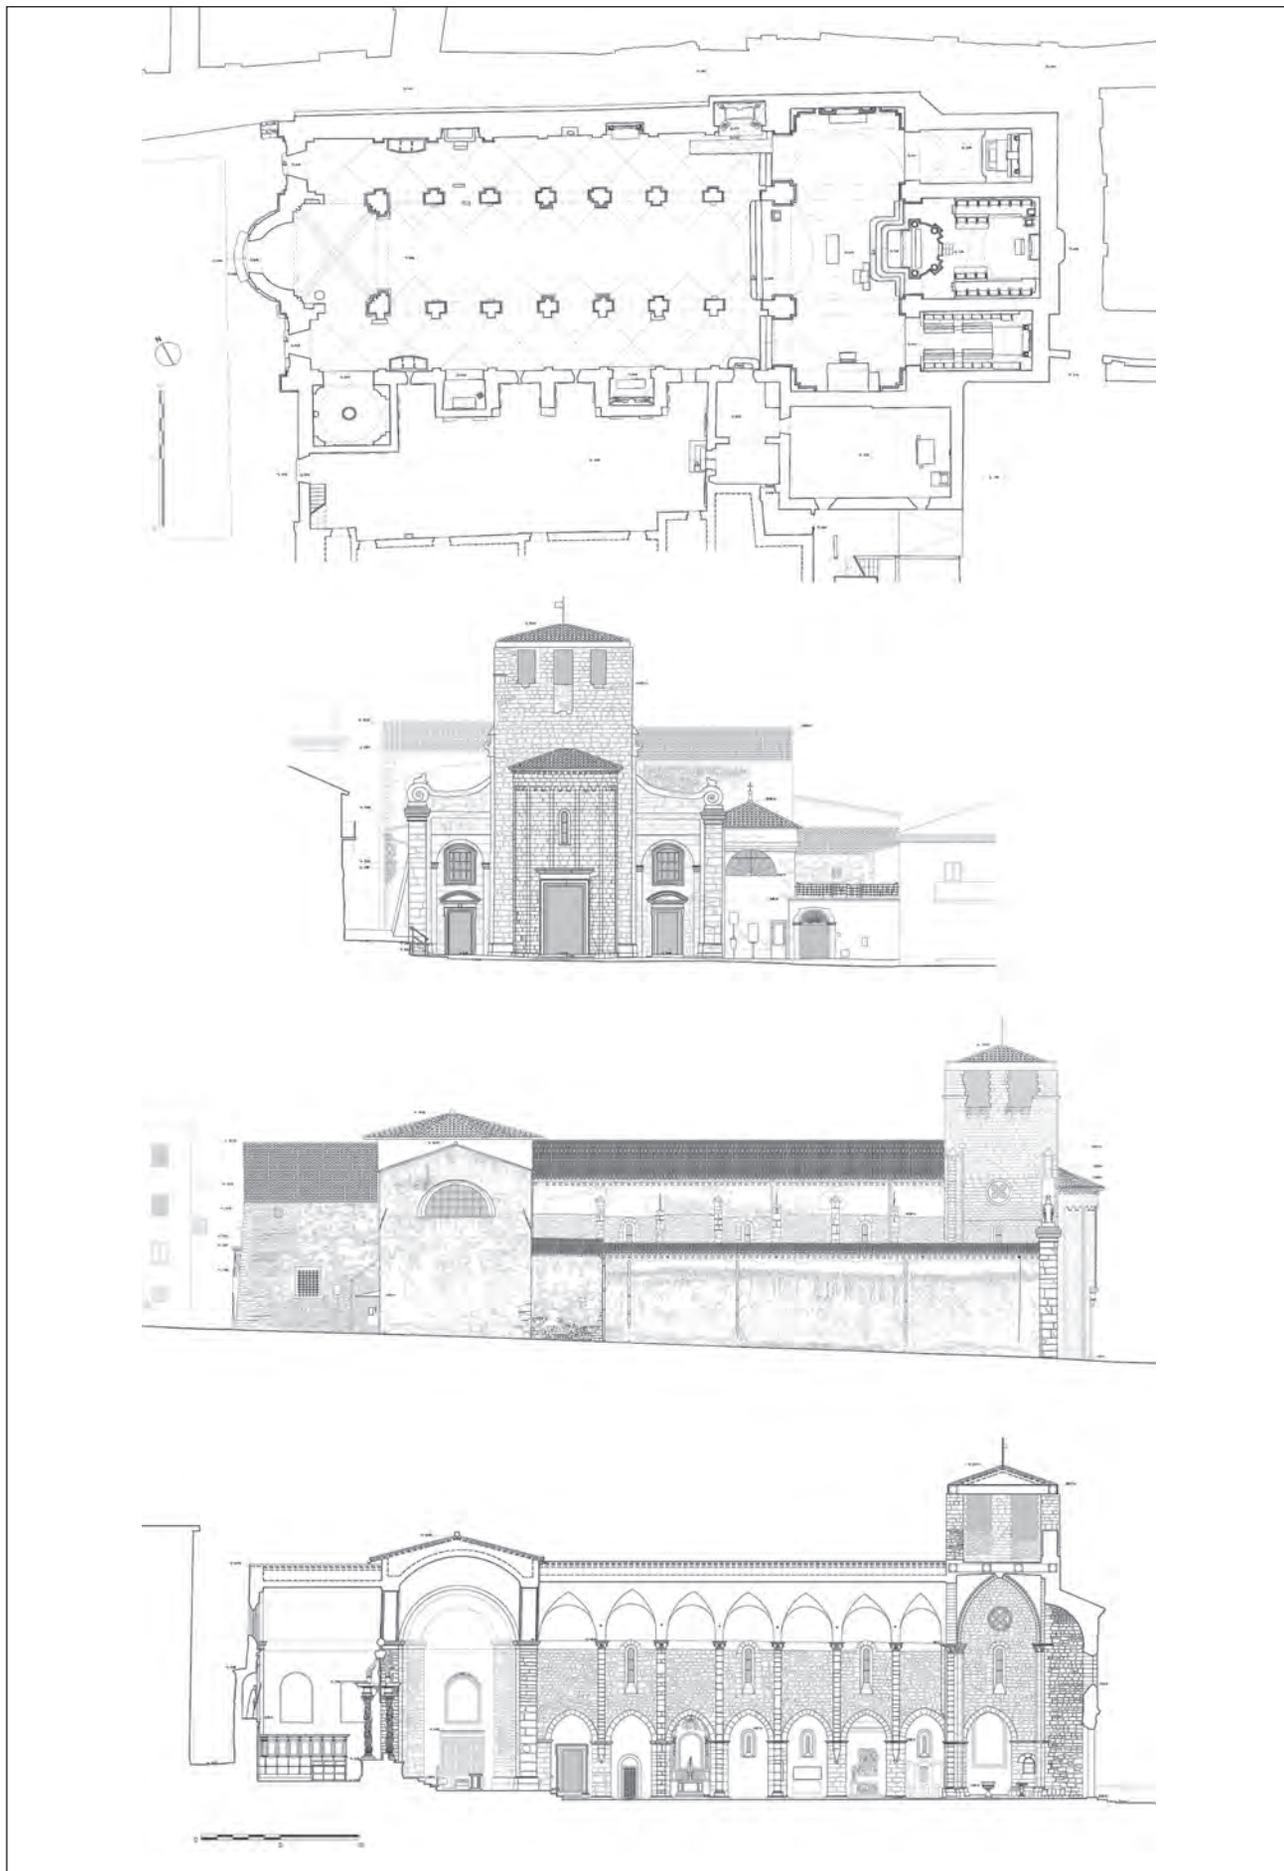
Sezze, Santa Maria: pianta, facciata, prospetto laterale nord e sezione longitudinale (rilievo dell'autore e di S. Greci; elaborazione grafica di S. Greci).
